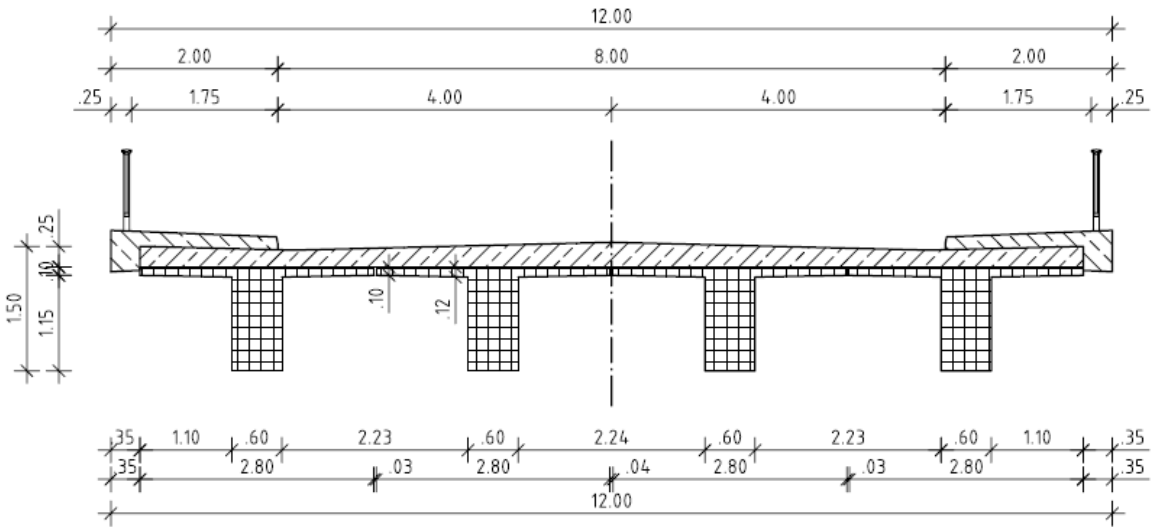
Skizze Fertigteilquerschnitt in Massivbauweise mit 8 m Fahrbahnbreite
